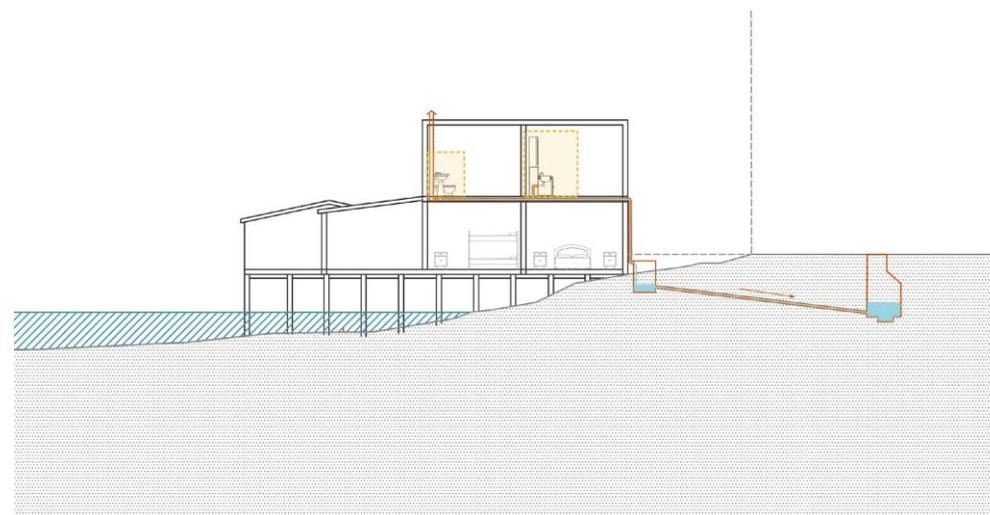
Corte explicativo de situación hipotética palafito de 2 pisos si se conectara actualmente al alcantarillado.
